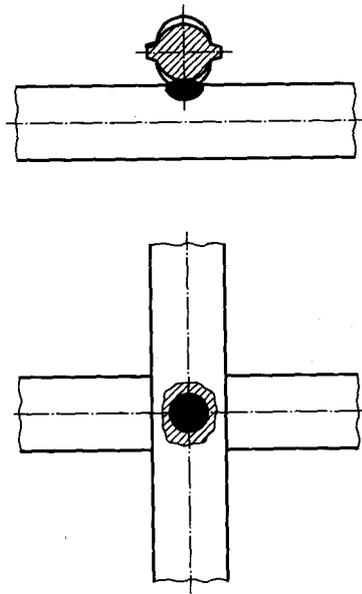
Kreuzungsstoß, geschweißt mit den Schweißprozessen 21 und 23
